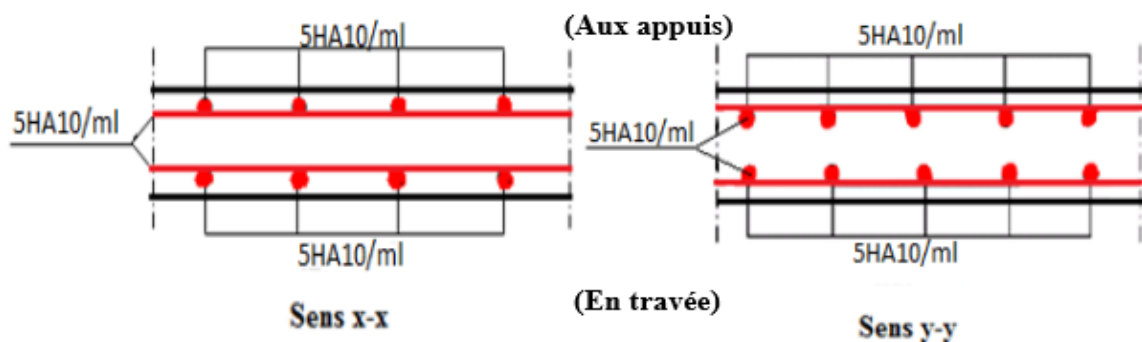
Schéma de ferrailage de la dalle de salle machine.
